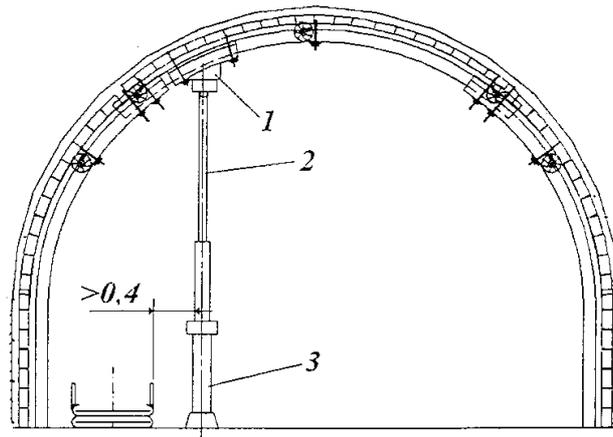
Установка крепи усиления в участковой выработке: 1 – спец-верхняк с опорой; 2 – удлиненная насадка УГД-3; 3 – гидростойка
